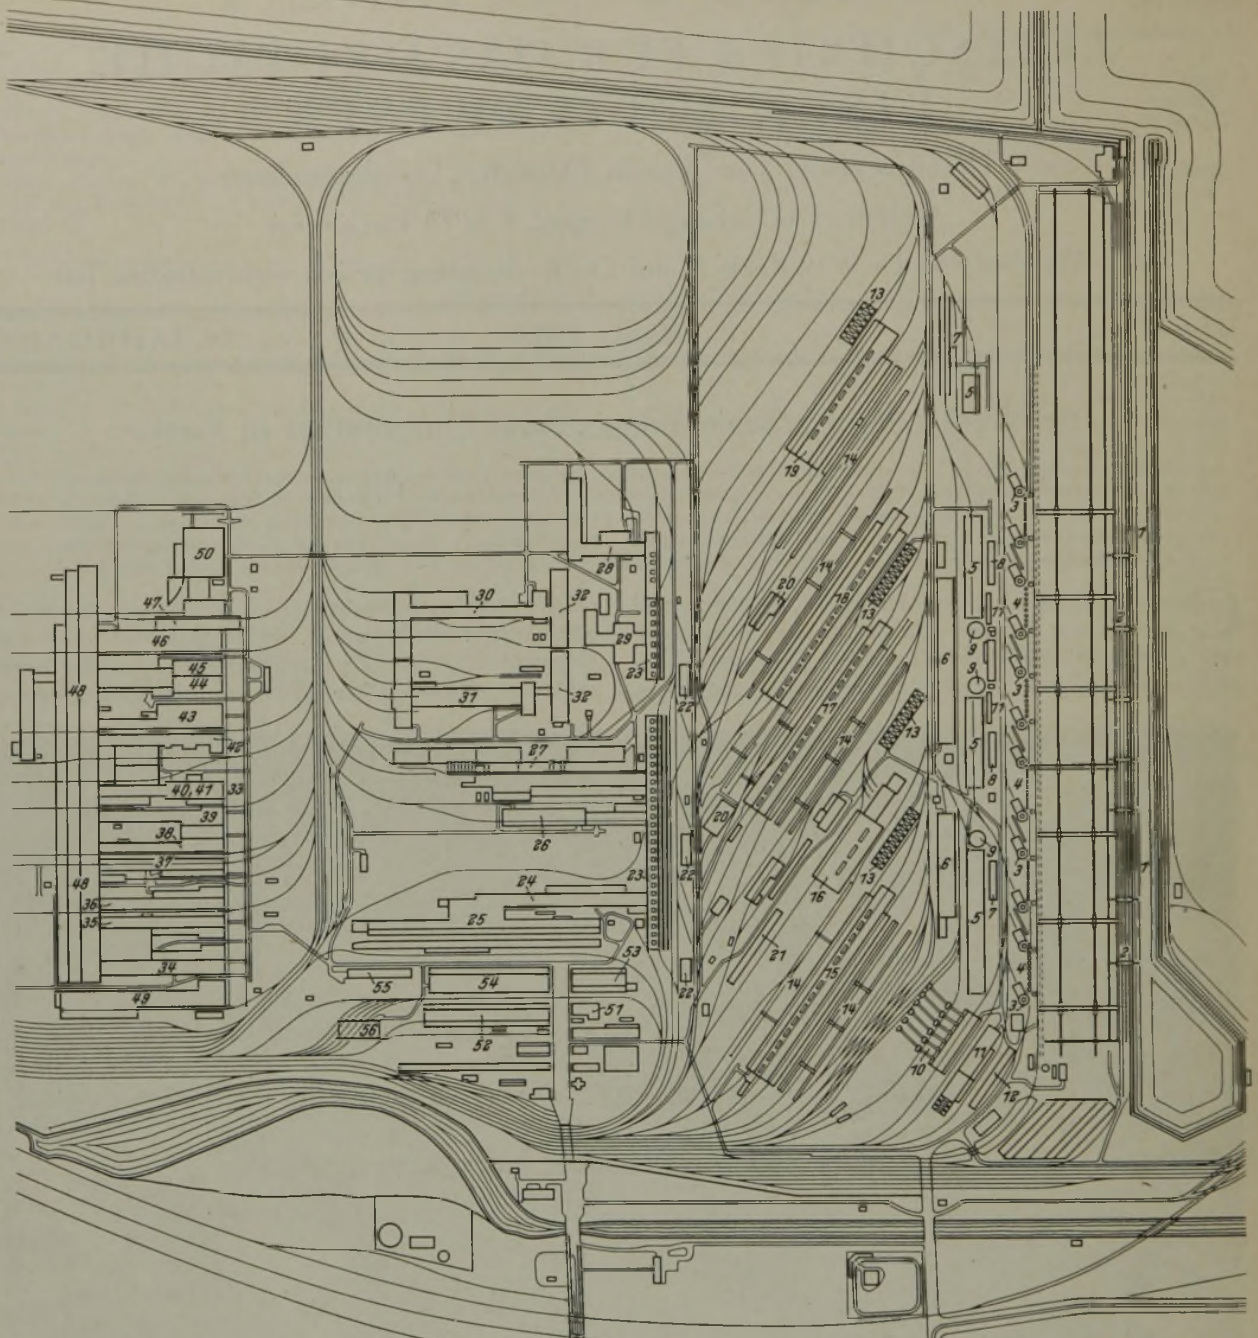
Grundriß der Hochofen-, Stahl- und Walzwerksanlagen.
